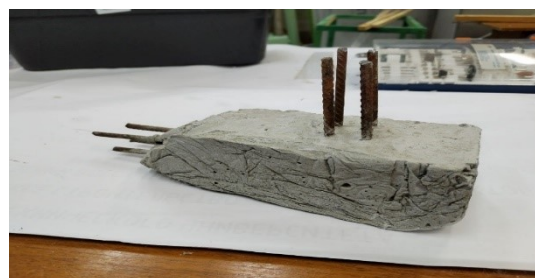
Выход арматуры из фундамента реконструированного здания
